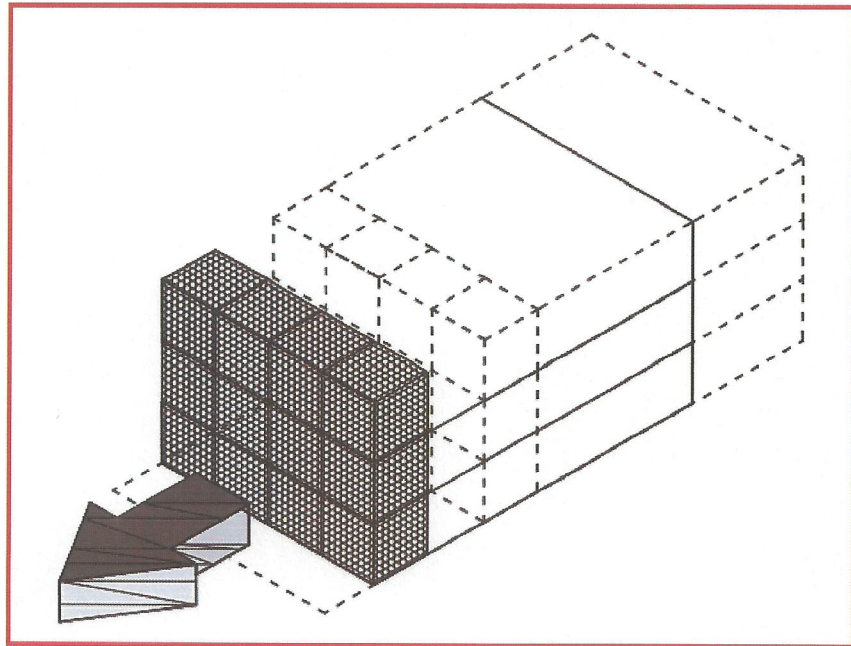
Deslizamiento del bloque reforzado sobre la fundación.
